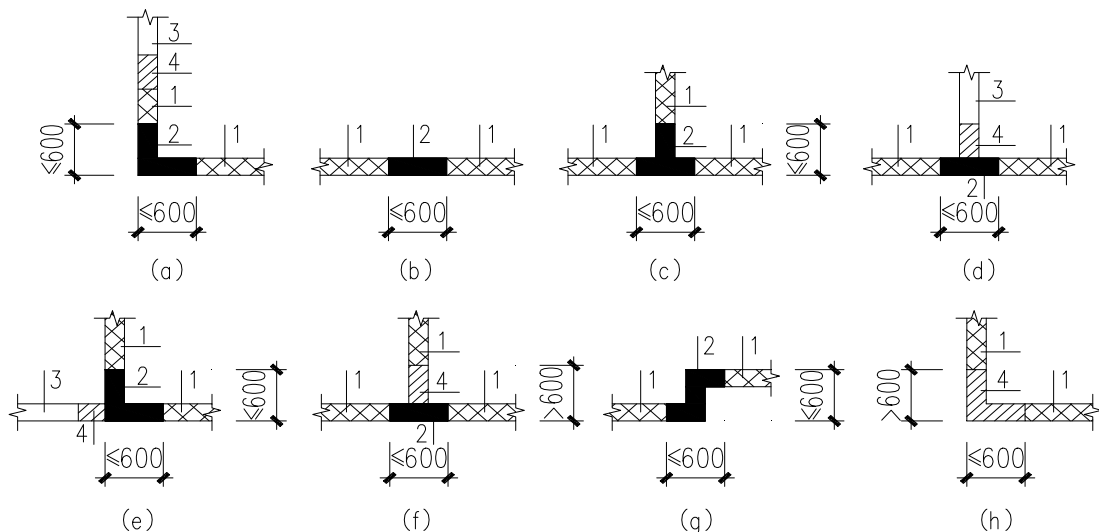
预制剪力墙板间可计入预制混凝土体积的现浇段示意图
